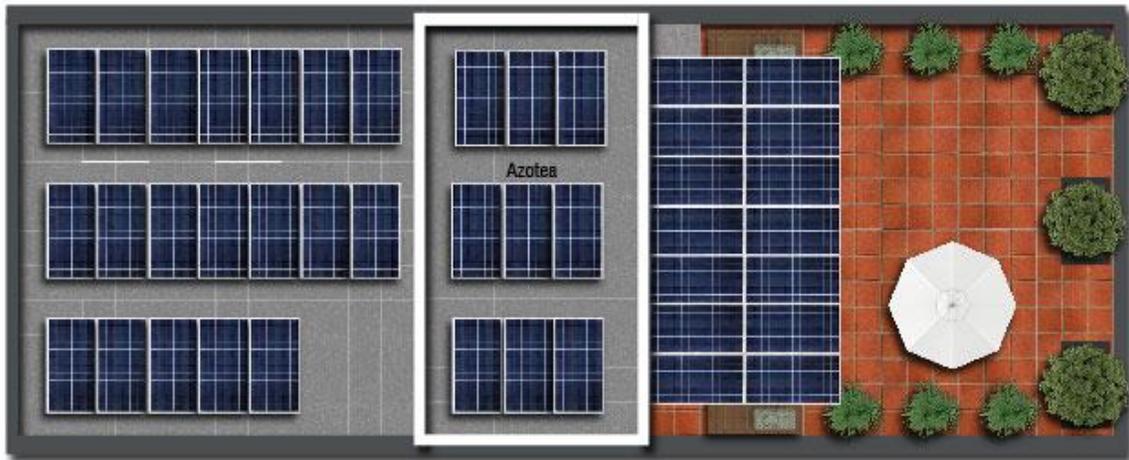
Planta de azotea Fuente: Elaboración propia
